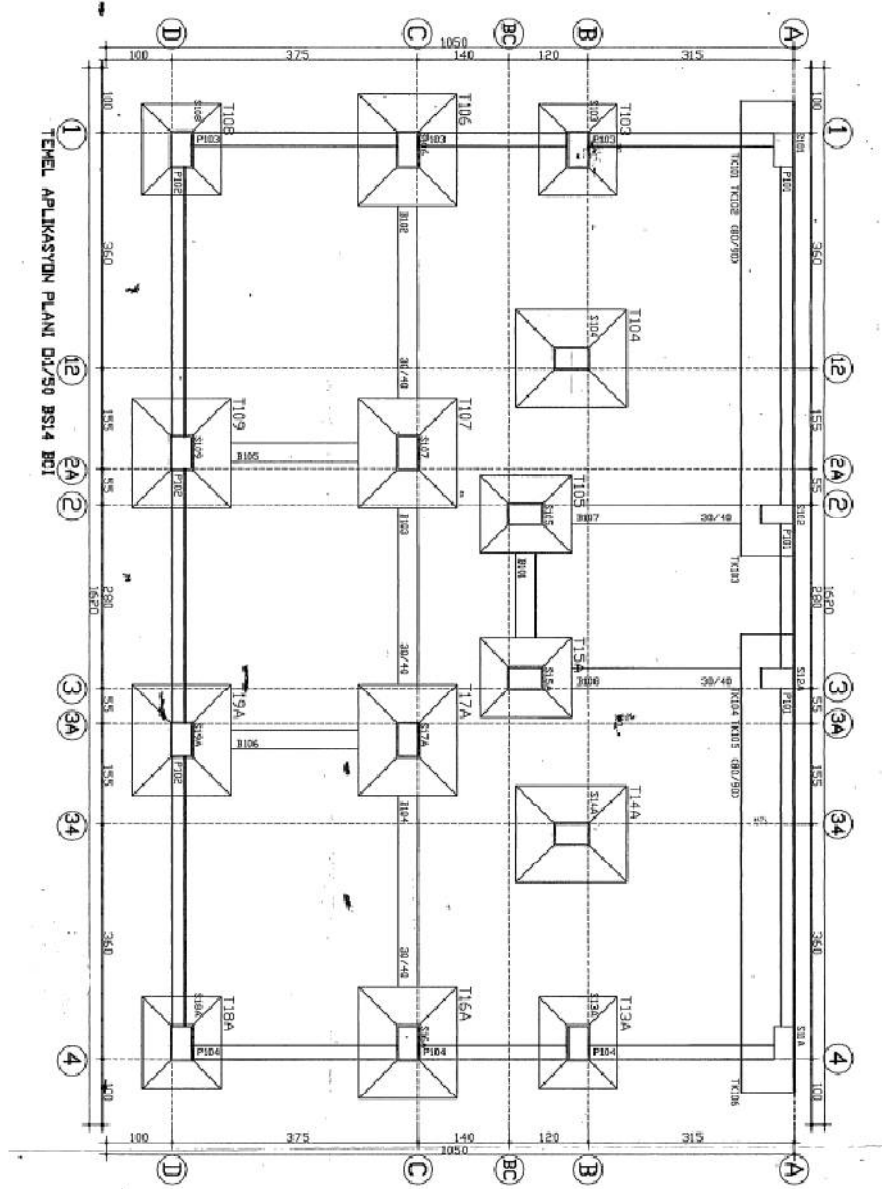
(2) Nolu bina temel aplikasyon planı
